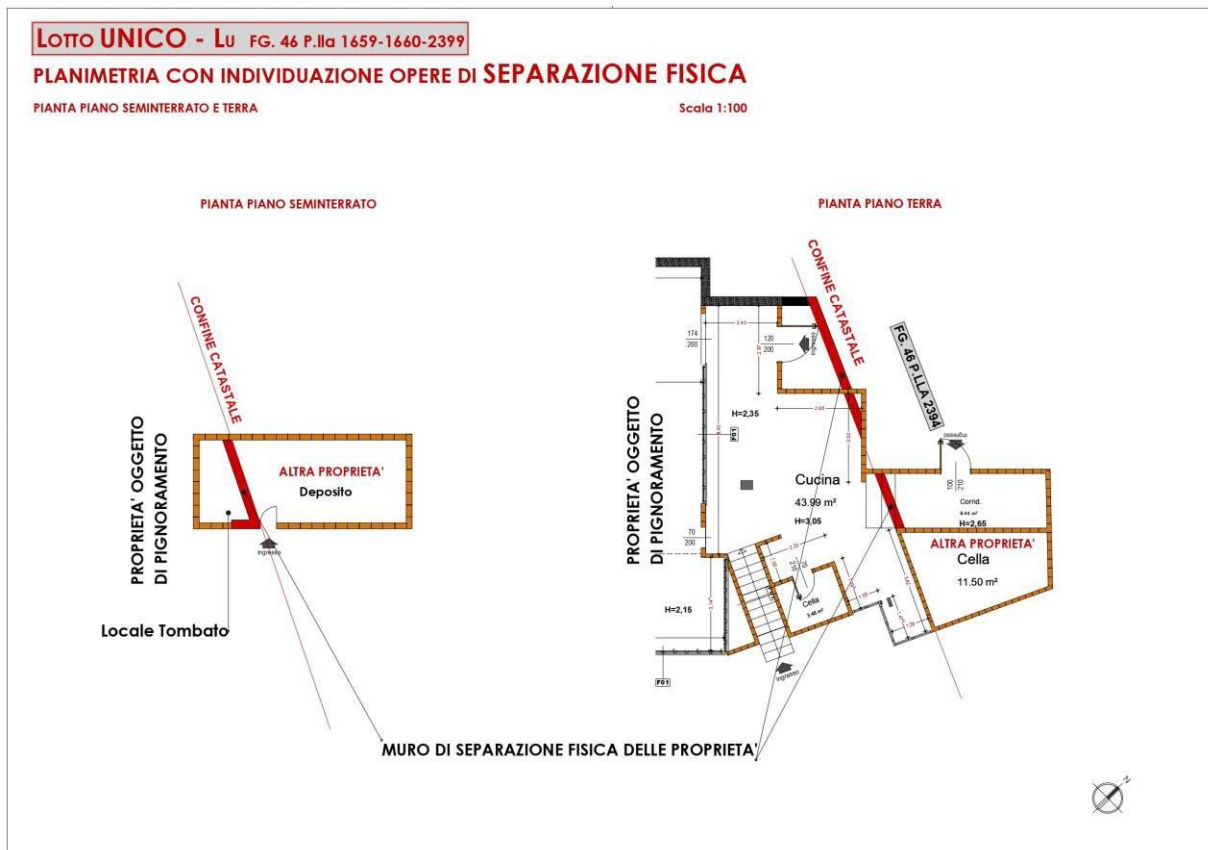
Plan. Con Individuazione opere di SEPARAZIONE FISICA Lotto LU – P. S. e P.T. (ALL. 15).
